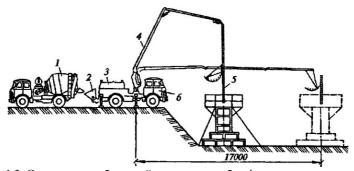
Схемы подачи бетонной смеси в опалубку фундамента при помощи бетононасоса: 1 – бетоновоз, 2 – приемный бункер, 3 – бетононасос, 4 – стрела, 5 – рукав
